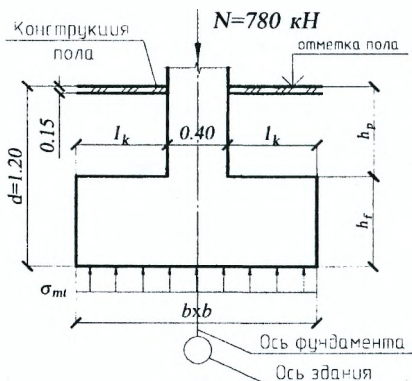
Расчётная схема столбчатого фундамента (размеры в метрах)
